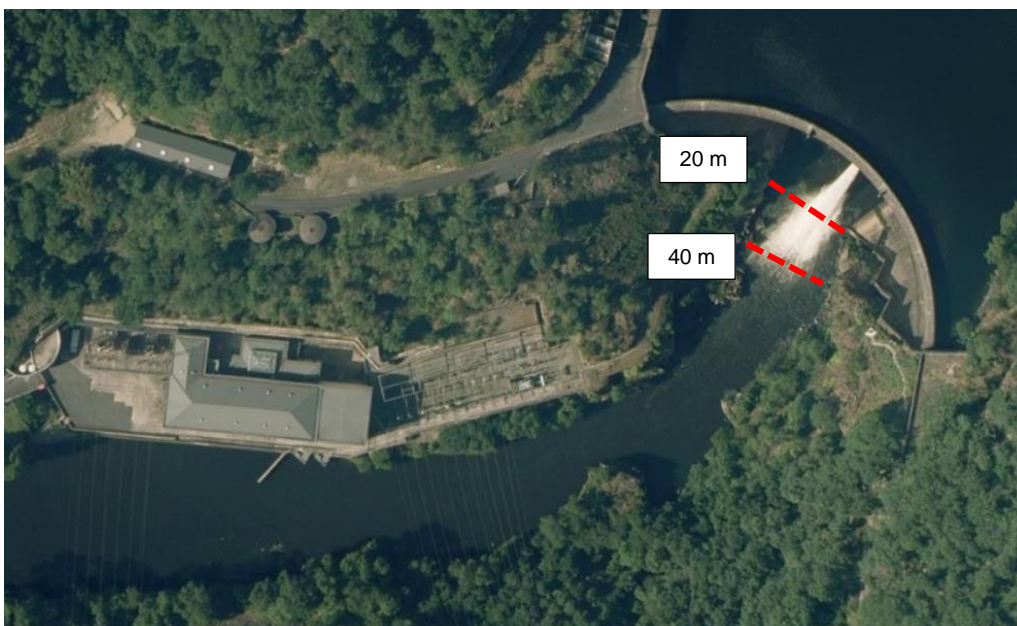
Possibles localisations du batardeau (20 et 40 m) (source : Geoportail)
